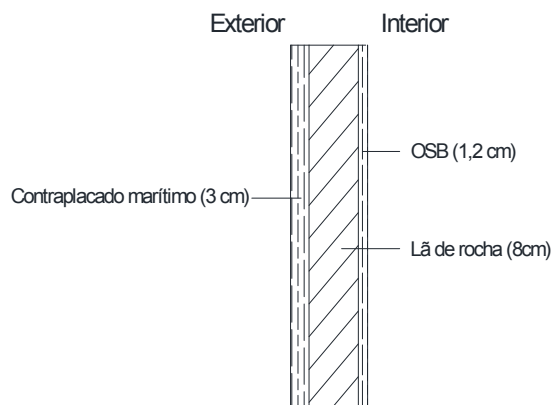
Parede exterior dupla em contraplacado marítimo e OSB
